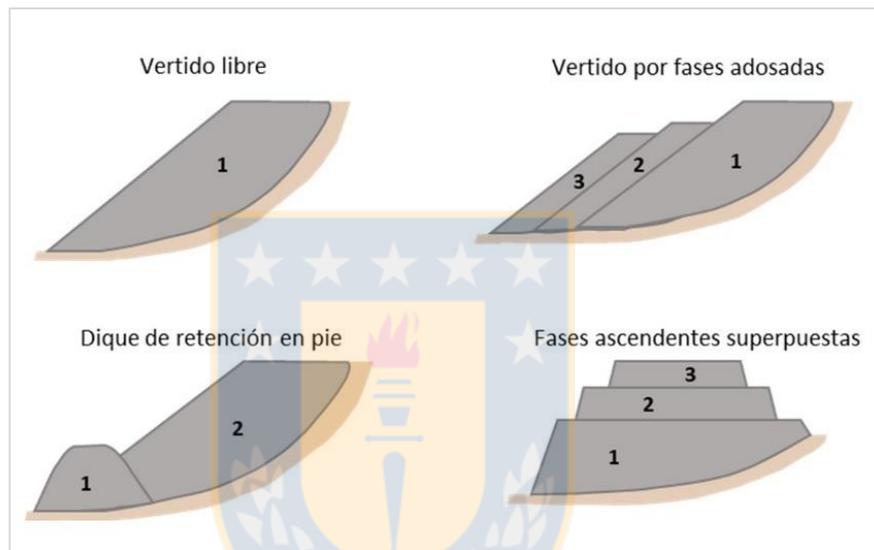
Tipos de botaderos de acuerdo a la secuencia de construcción.
